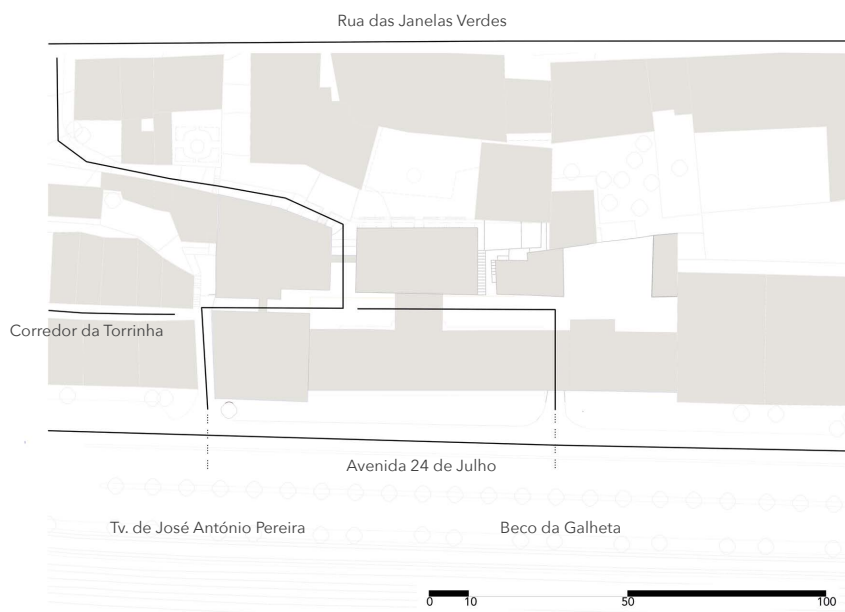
Planta com a indicação das vias que abrangem a zona de intervenção
